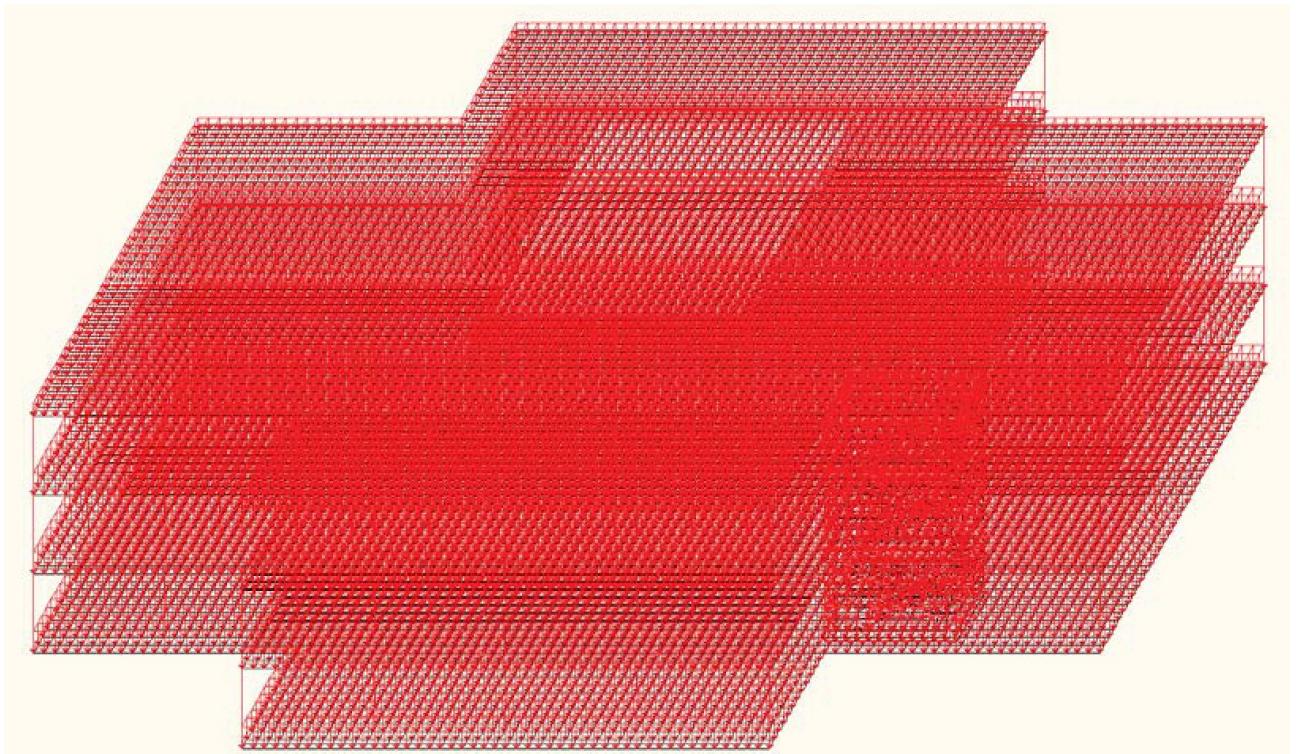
Схеми завантажень будівлі від власної ваги
